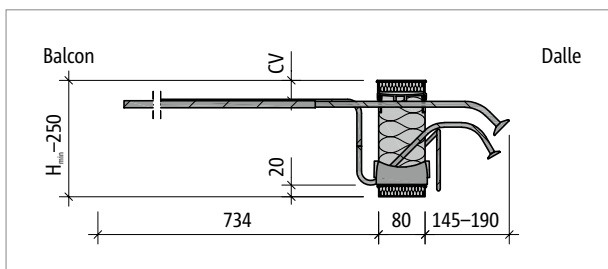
Schöck Isokorb® T type K-O-M4 : coupe du produit
